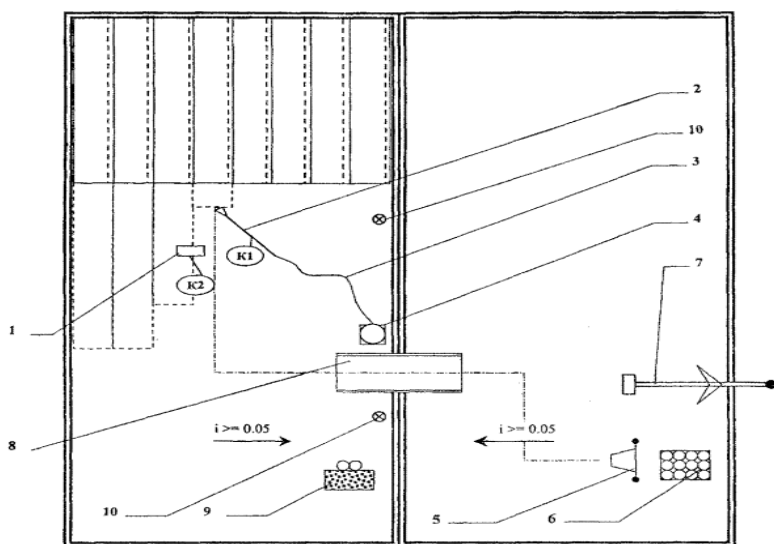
Схема организации рабочего места при работе по устройству кровли
